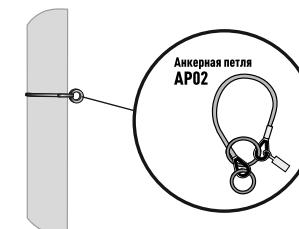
Монтаж анкерной петли AP02 к одной из опор.
